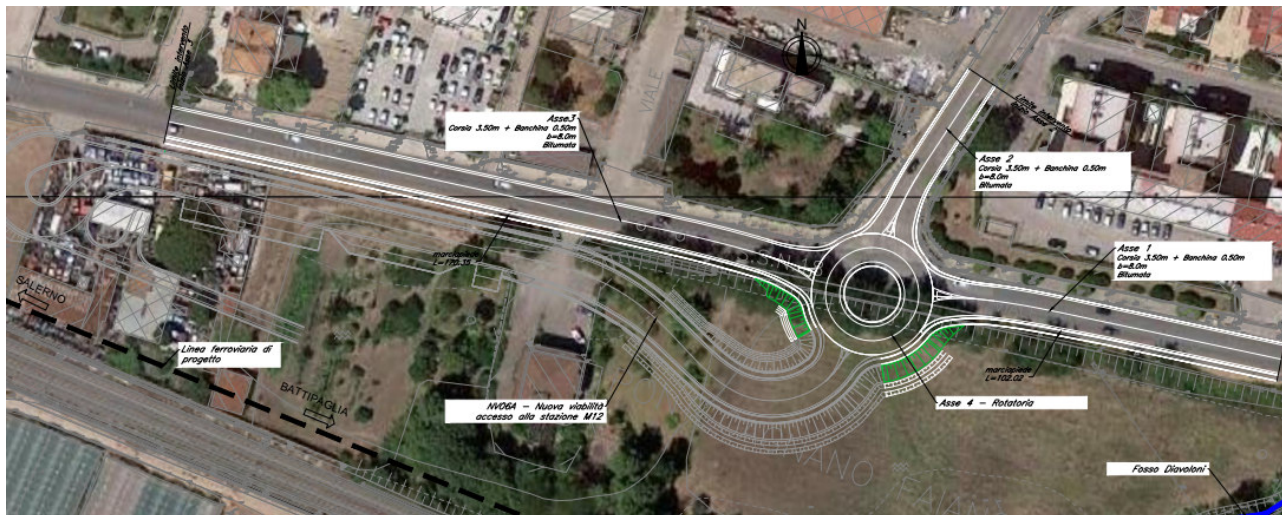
Stralcio planimetrico – NV06B_Adeguamento dell'intersezione su SS18 e riprofilatura rami di innesto
